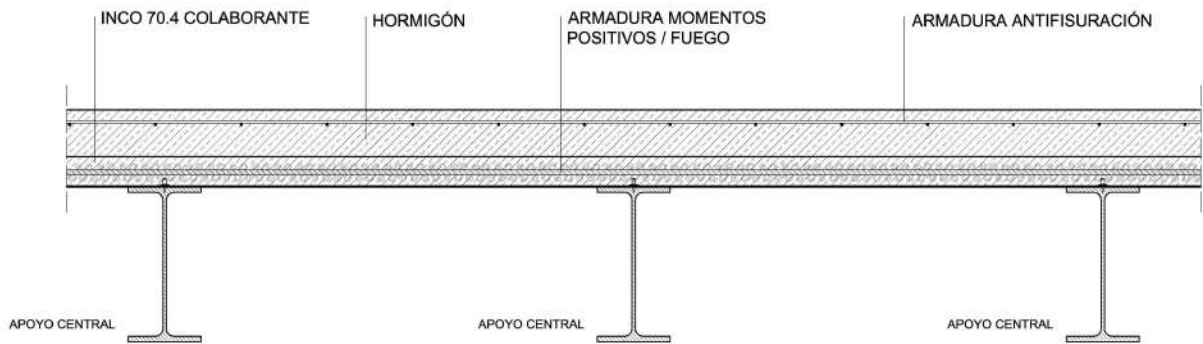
"Disposición de las armaduras de positivos/fuego sobre apoyos intermedios"
